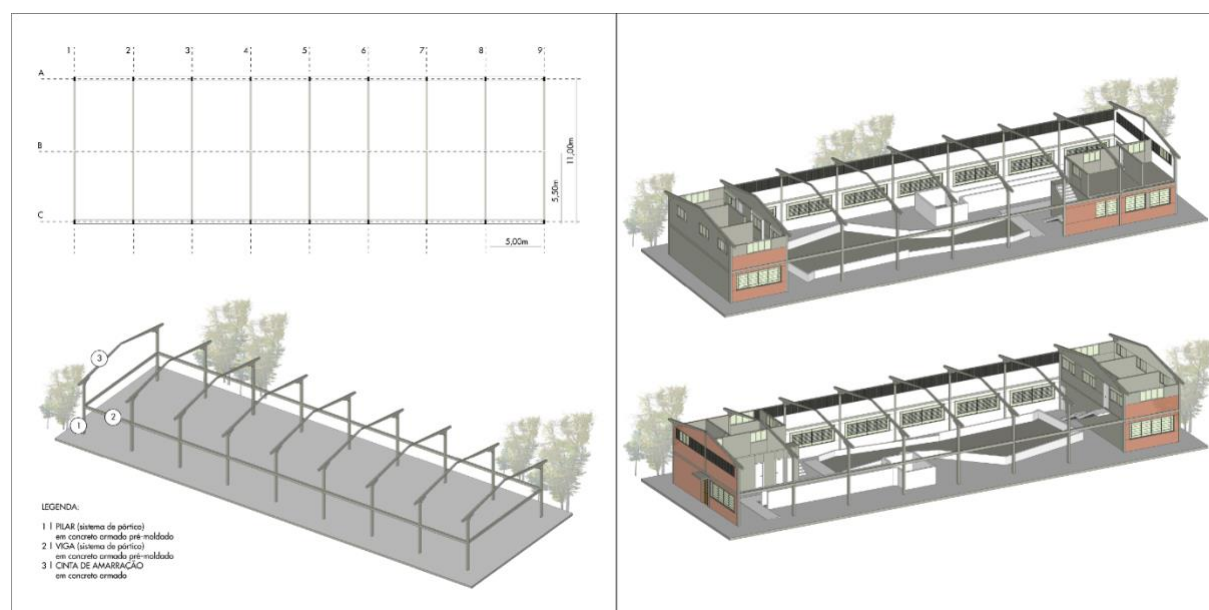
Estudo tectônico da estrutura de suporte e modulação do sistema construtivo pré-moldado (PL) do bloco BU. Fonte: Pereira, 2021.
